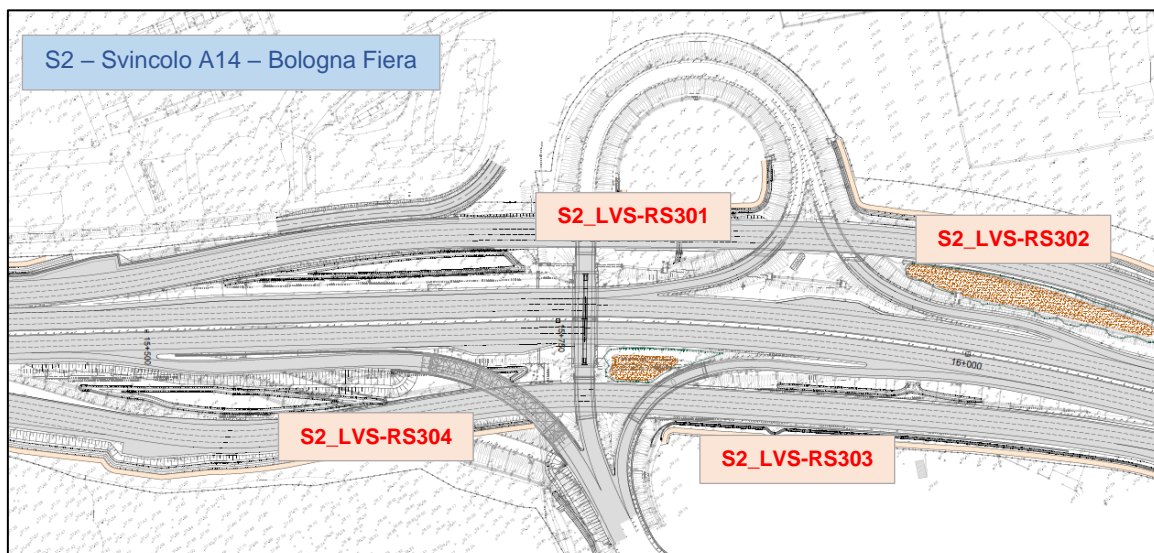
Stralcio planimetrico svincolo A14 Bologna – Fiera
